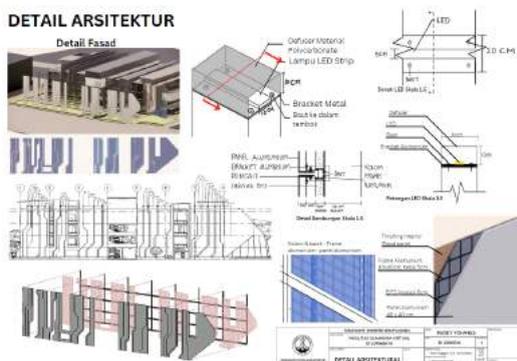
Keyplan Detail Kipas Bangunan
